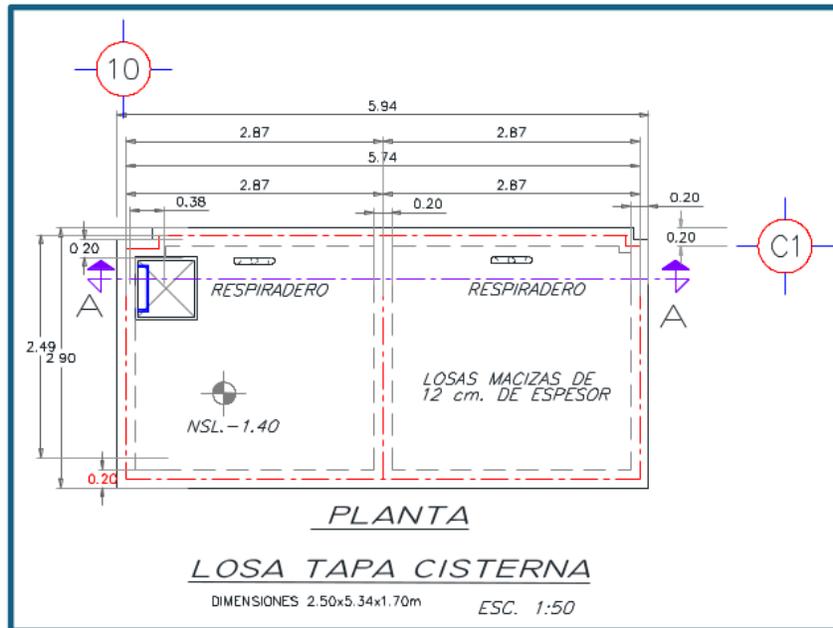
Planta de losa tapa de cisterna hidráulica
